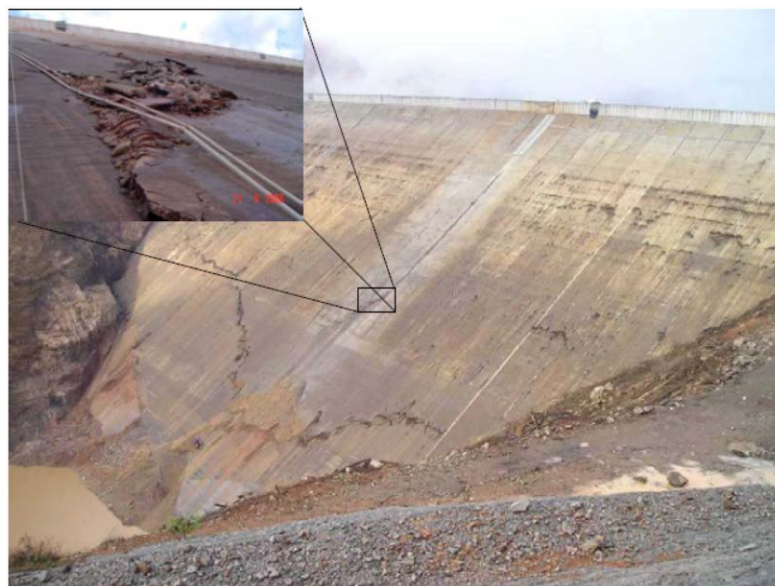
Roturas en la losa de concreto en la presa de enrocado Campos Novos (Pritchard, 2008)
